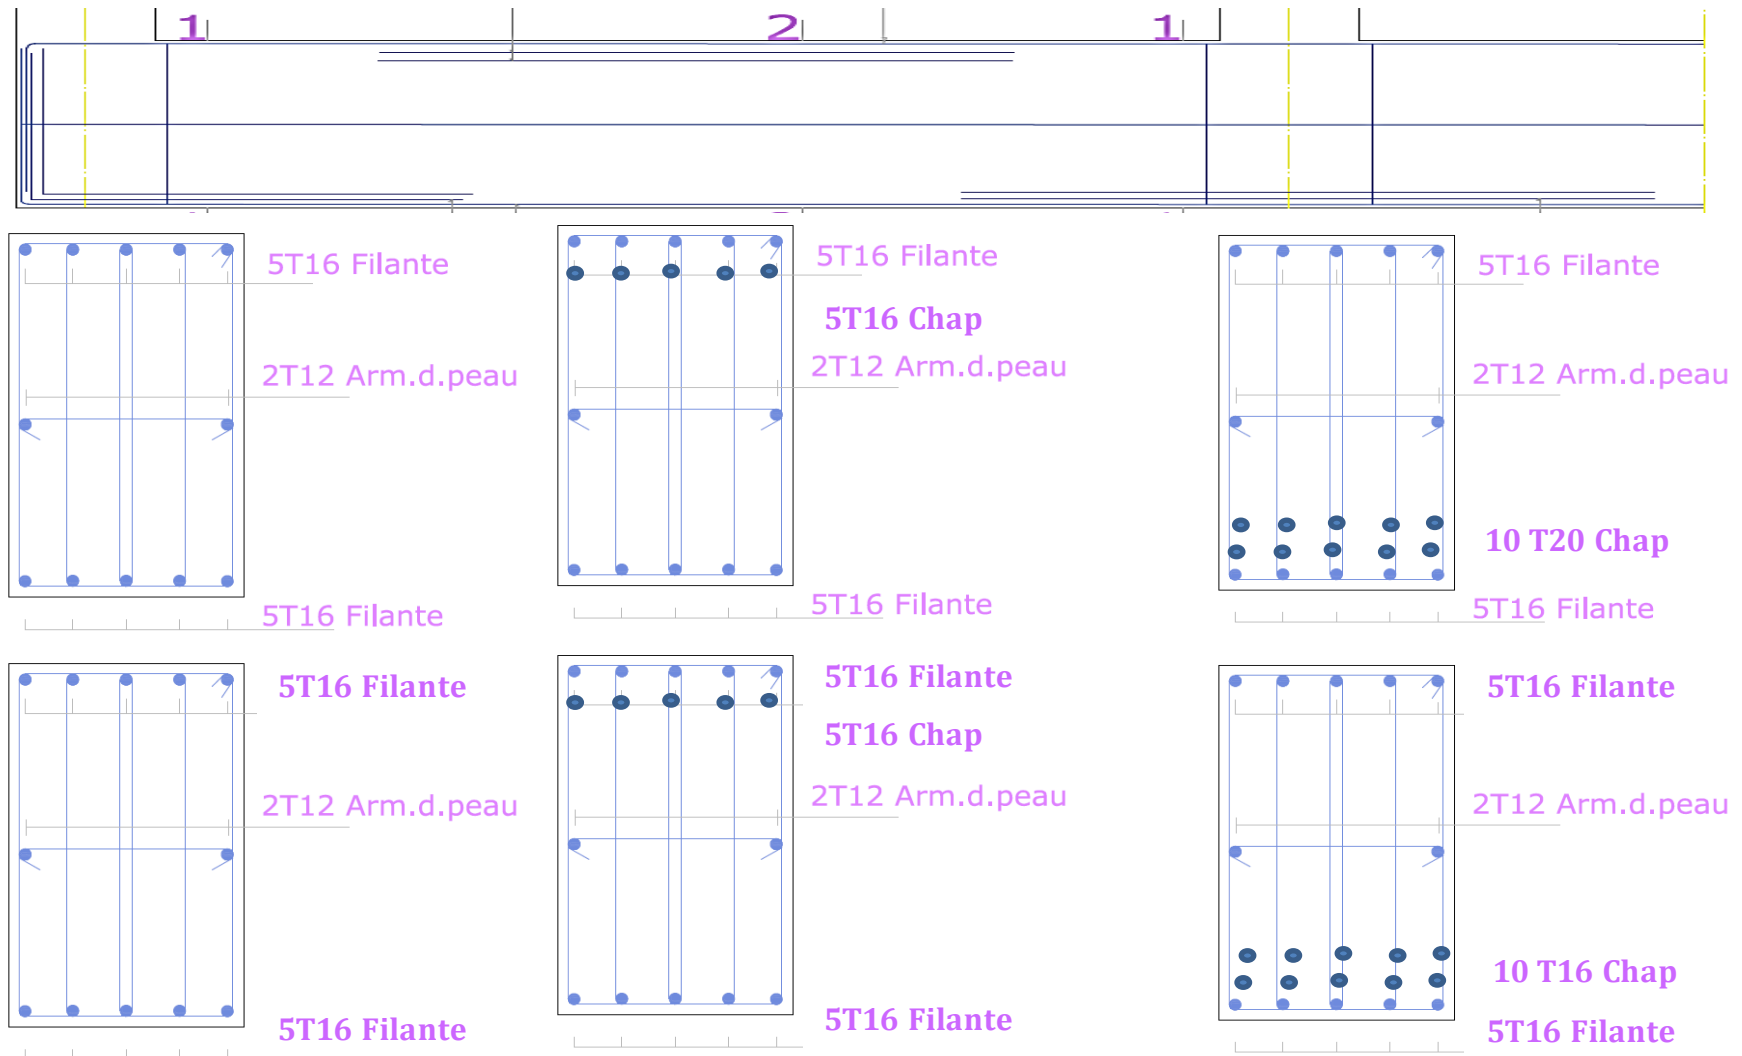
Schéma de ferrailage des poutres de rigidité –Principale et secondaire-
